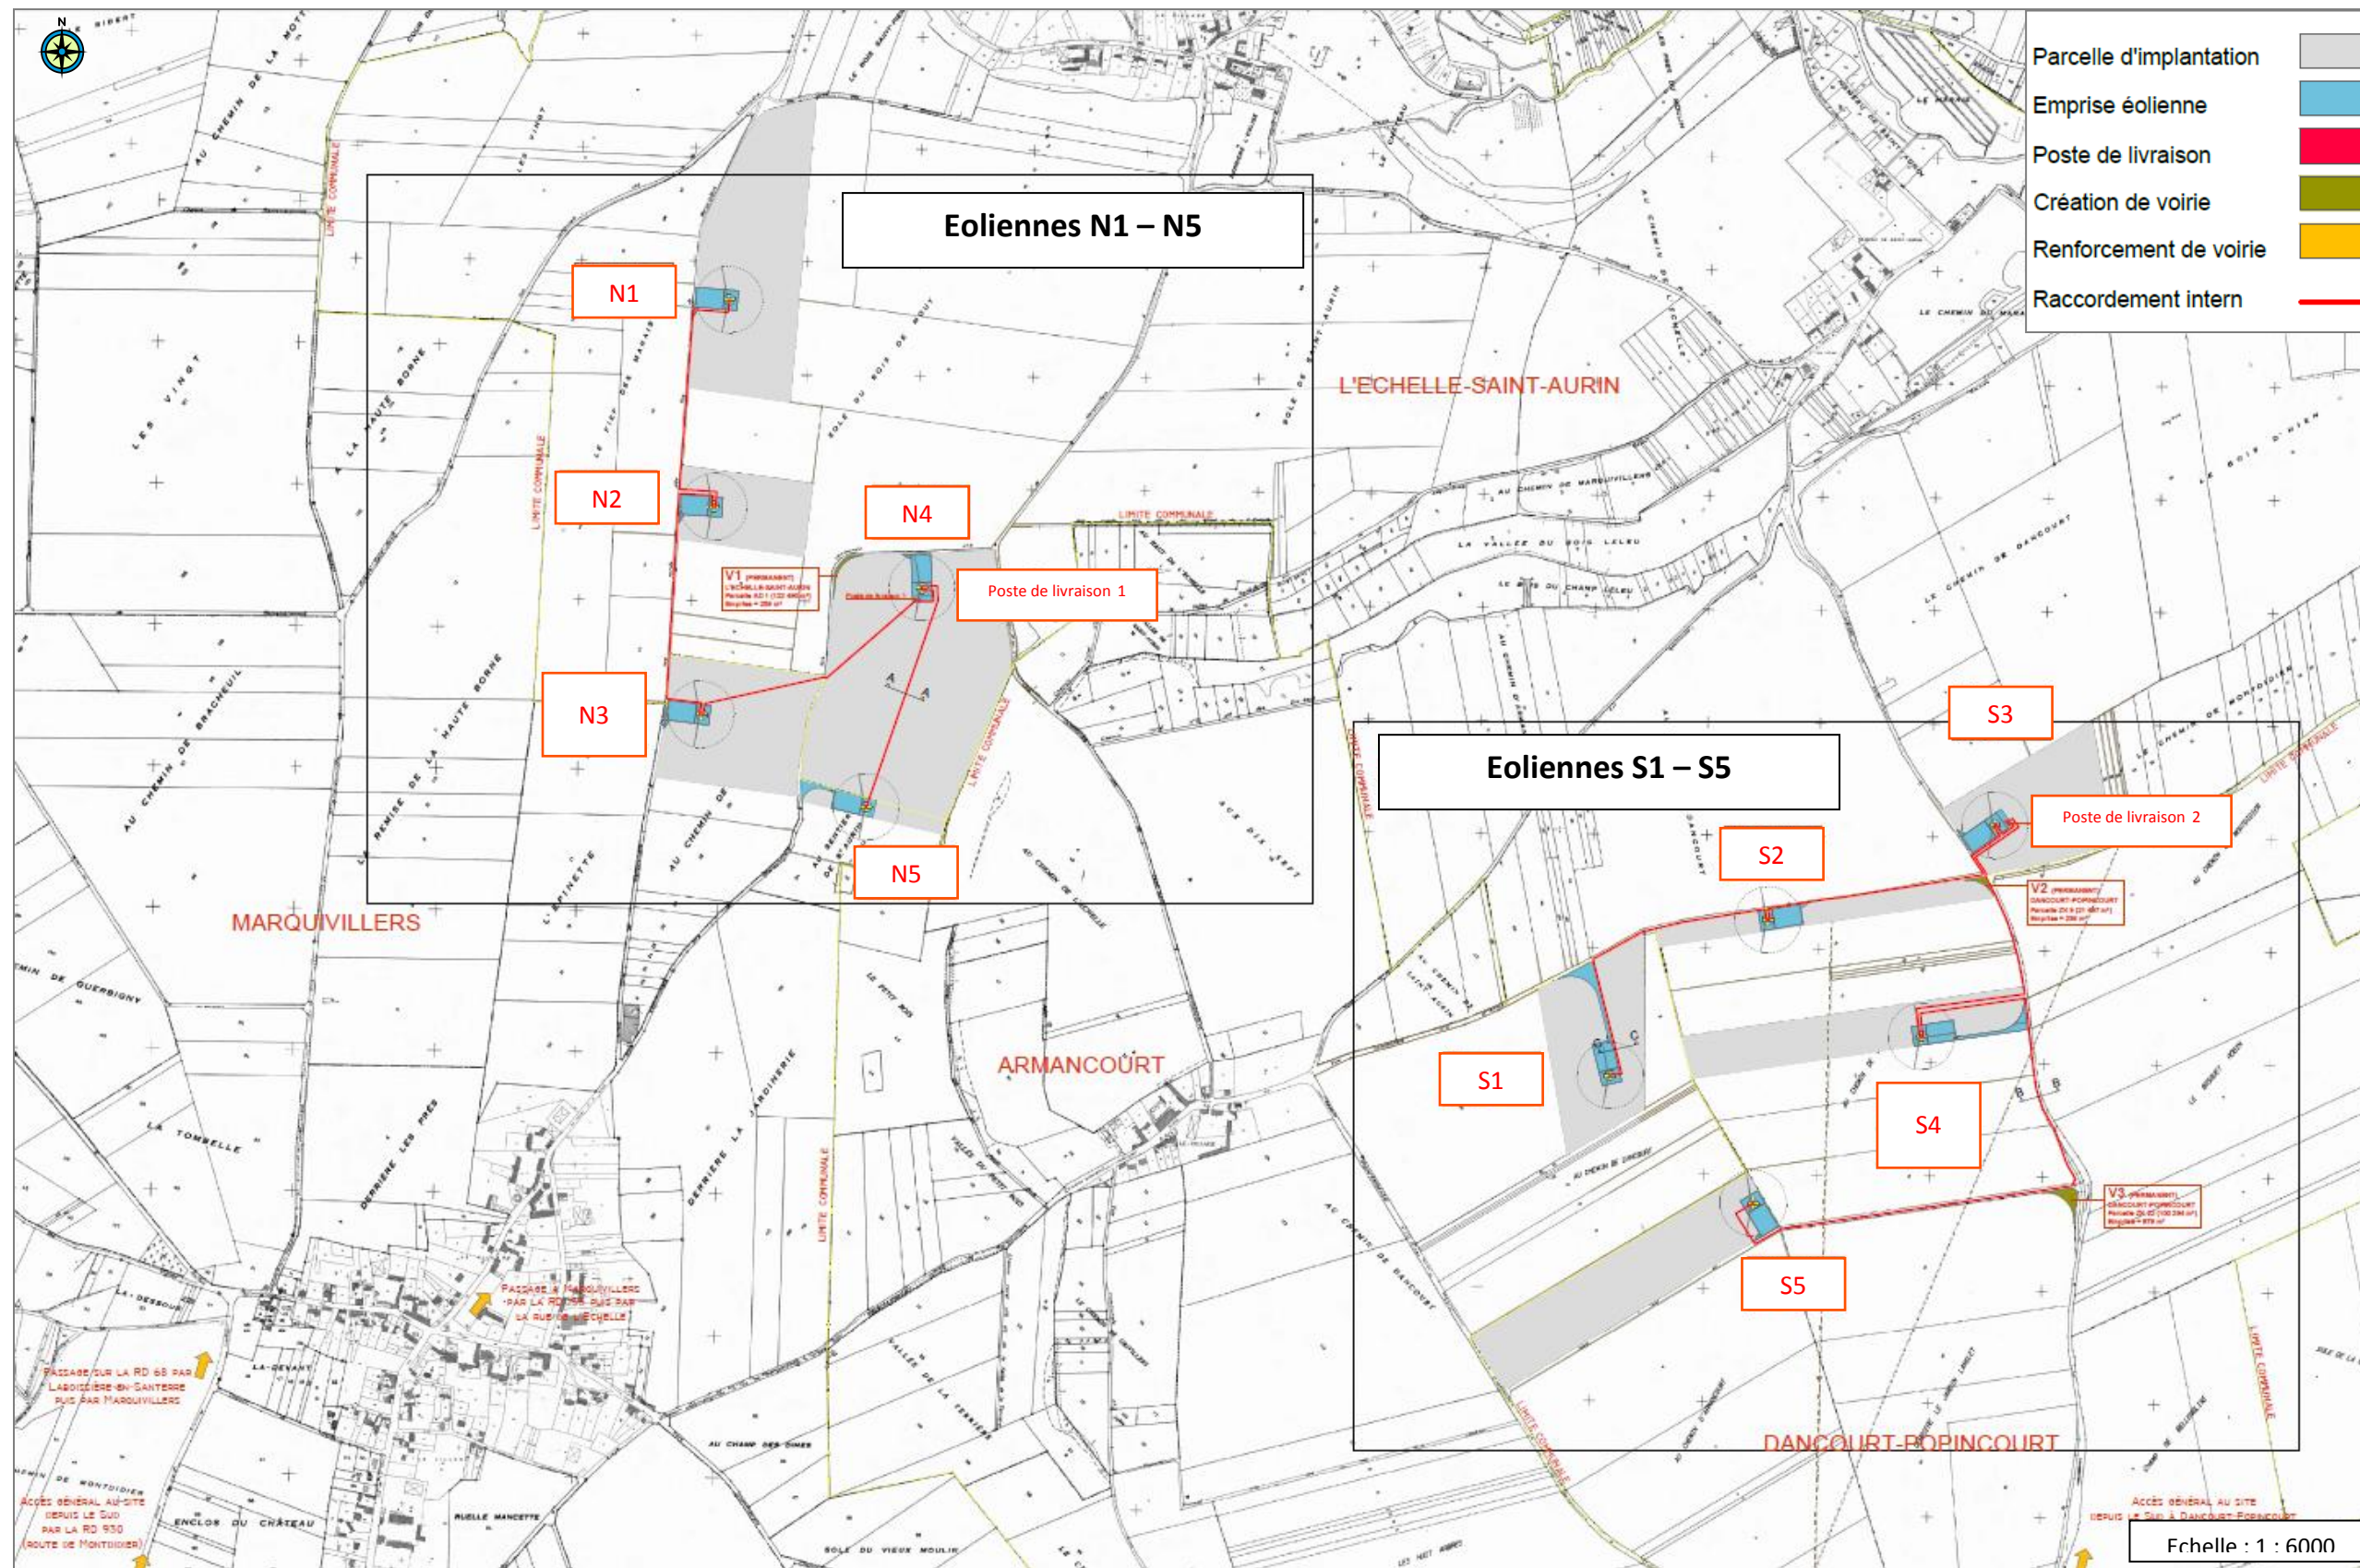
plan general d'implantation à l'échelle 1/6000ème
